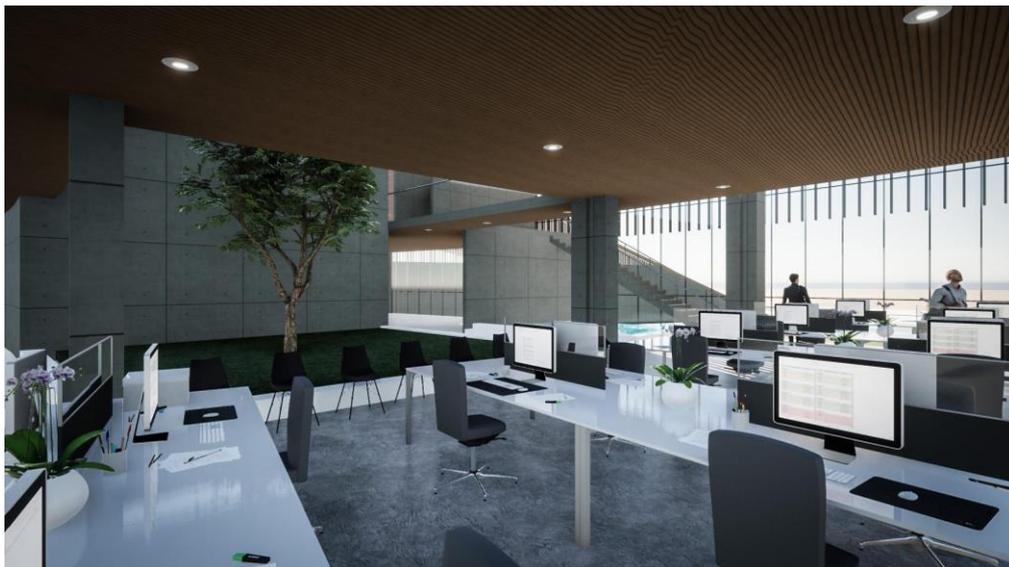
Vista 3D de la Biblioteca. Elaboración: Proyecto de Tesis
